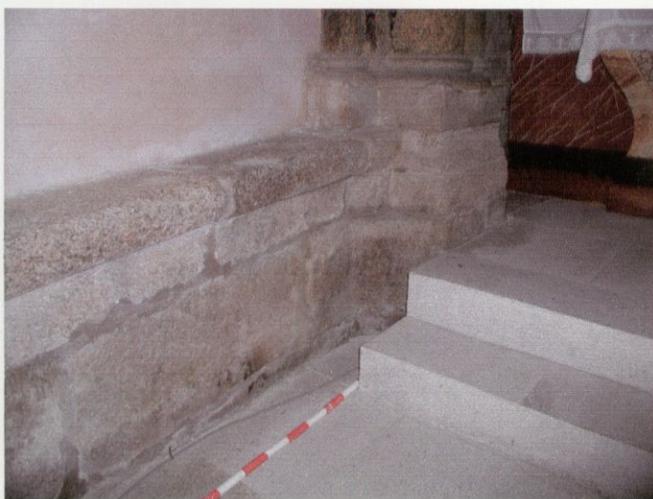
Sector SOA01/05. Cimentación del muro norte de la iglesia
